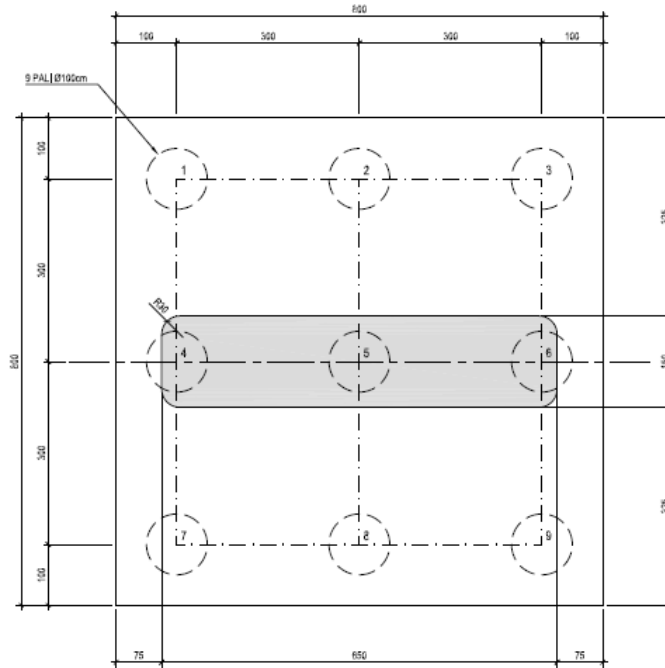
Pali fondazione Pila 1,2,3 e 4.
